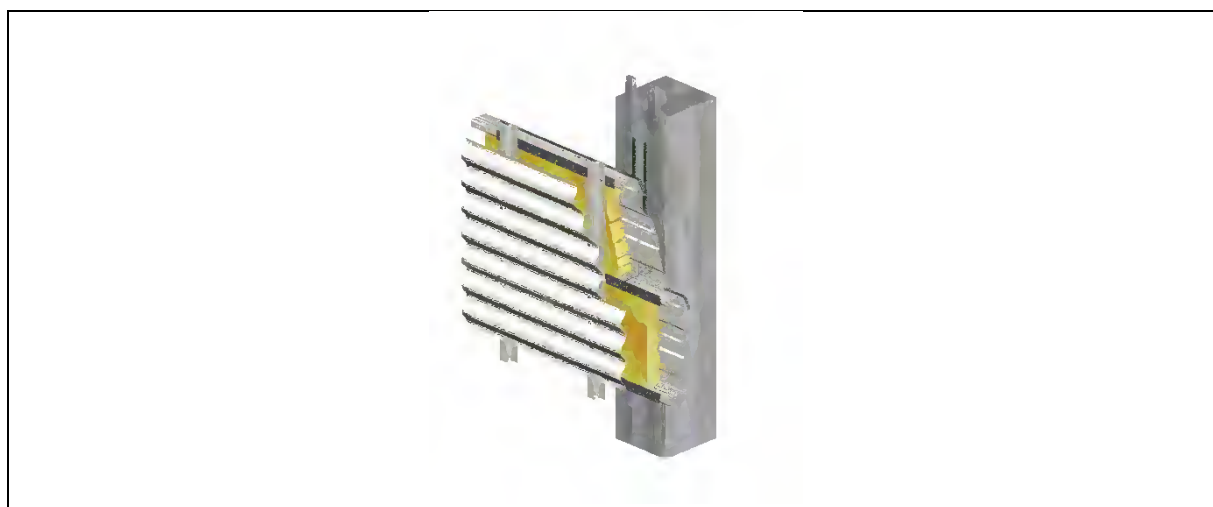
Kassettenelement mit modularem Stahlleichtbausystem
